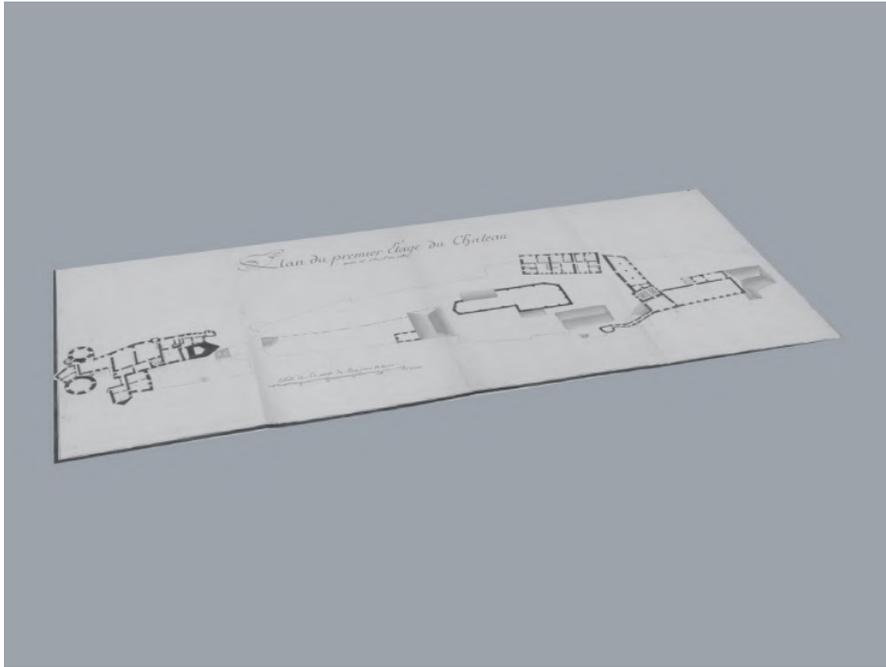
Plan de coupe Rhino du plan du premier étage du château
